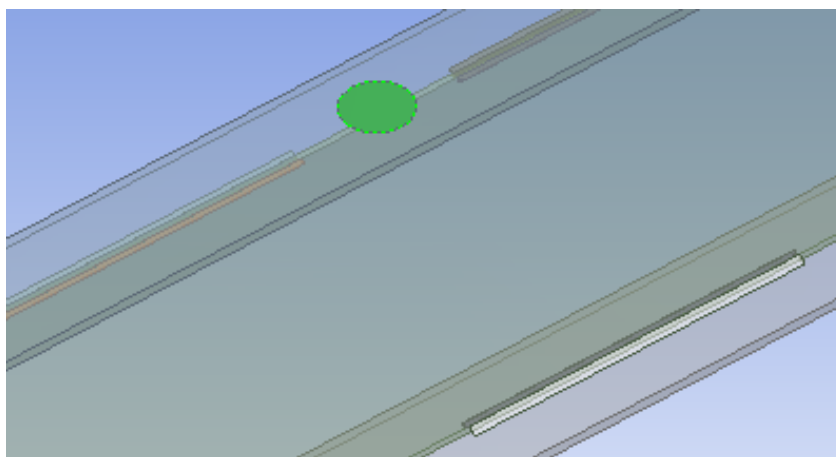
Asignación de material a los cordones de soldadura.
